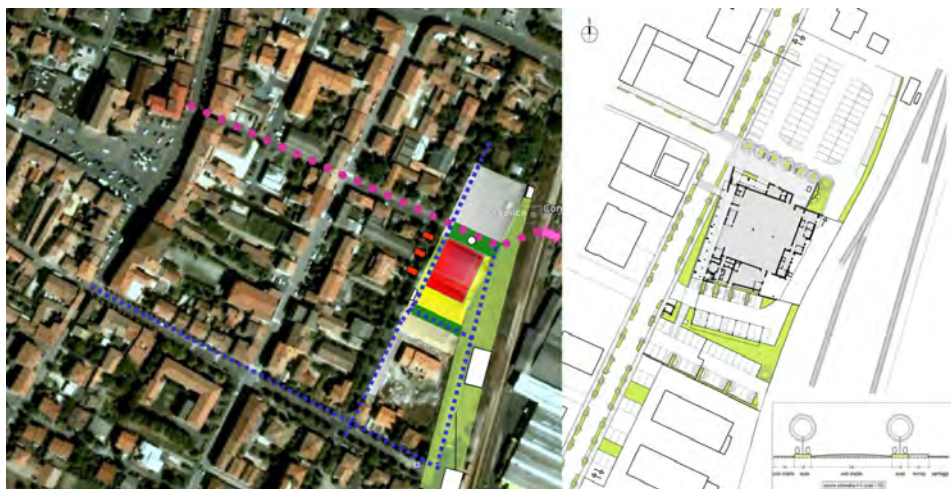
Schema preliminare dell’assetto urbanistico (a sinistra) e planimetria generale del progetto realizzato.
